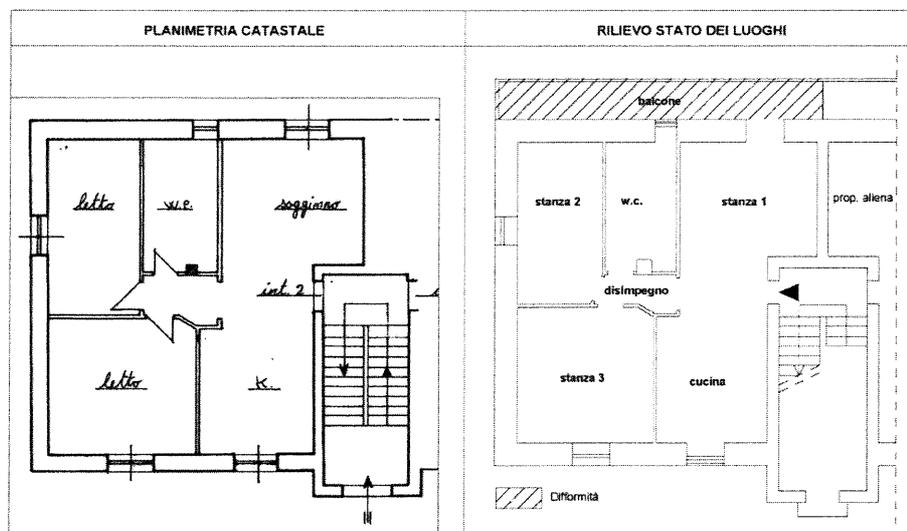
Confronto tra la planimetria catastale attuale e il rilievo dello stato dei luoghi. Campita con tratteggio la difformità.
